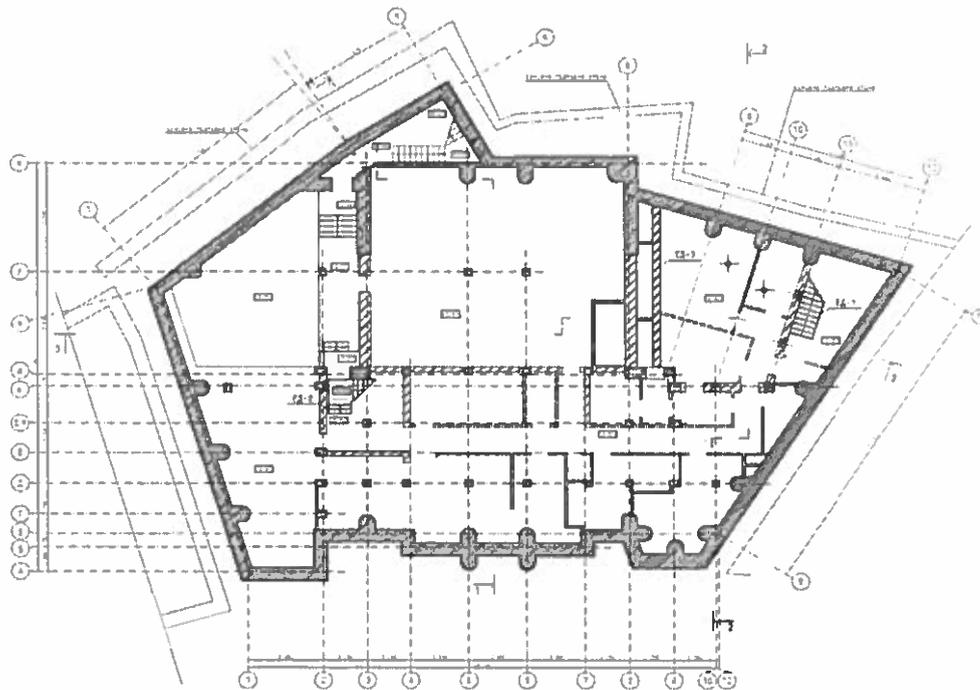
План будівлі на відмітці -9,800 [2]
